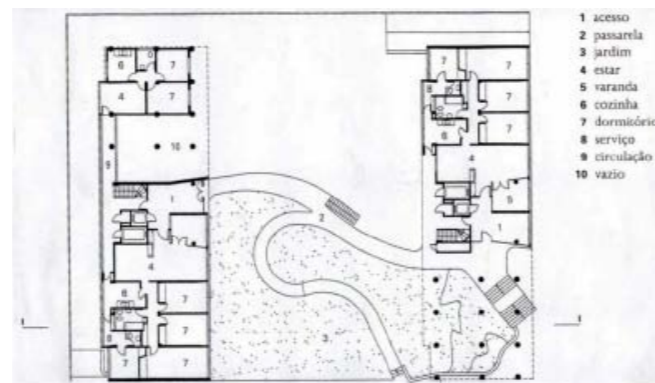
Planta do conjunto. Fonte: Revista 2G.
